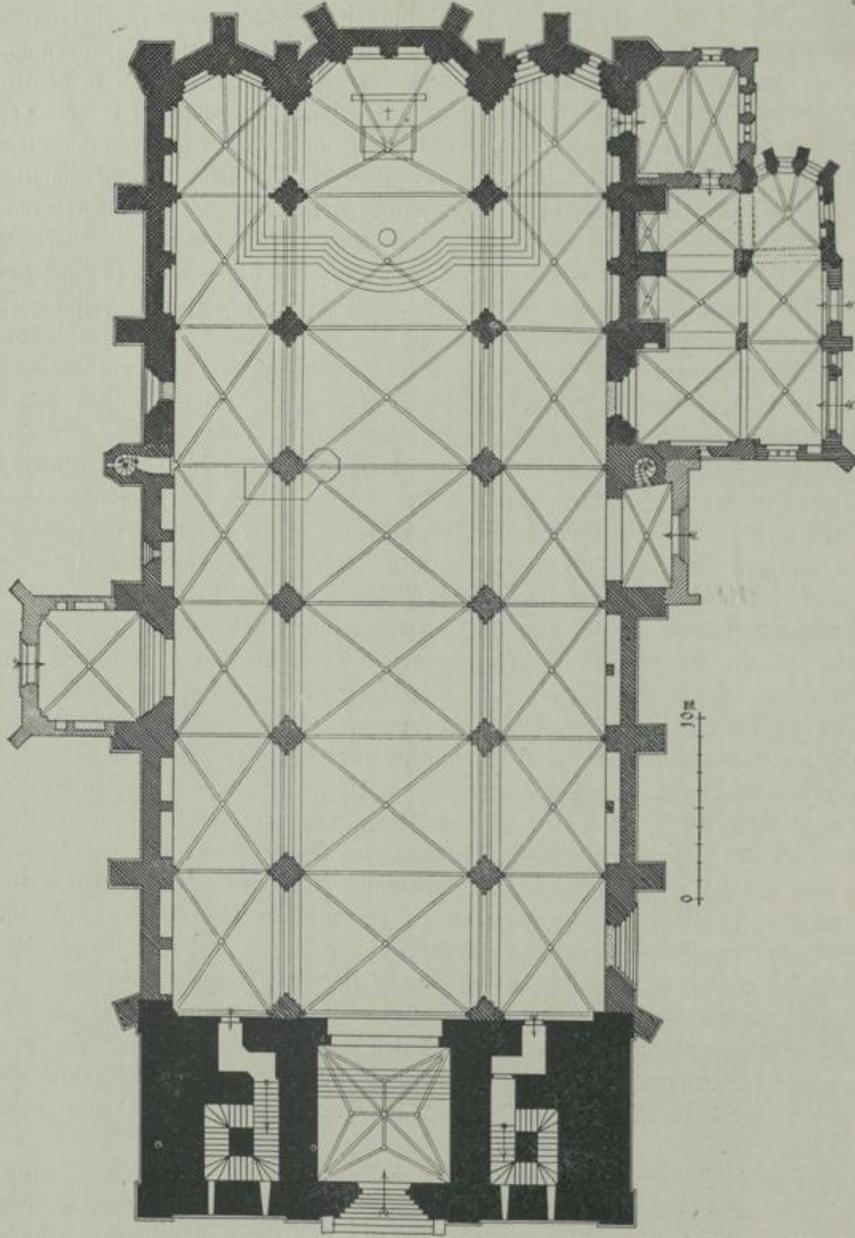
Prenzlau. Marienkirche. Grundriß im Erdgeschoß.
